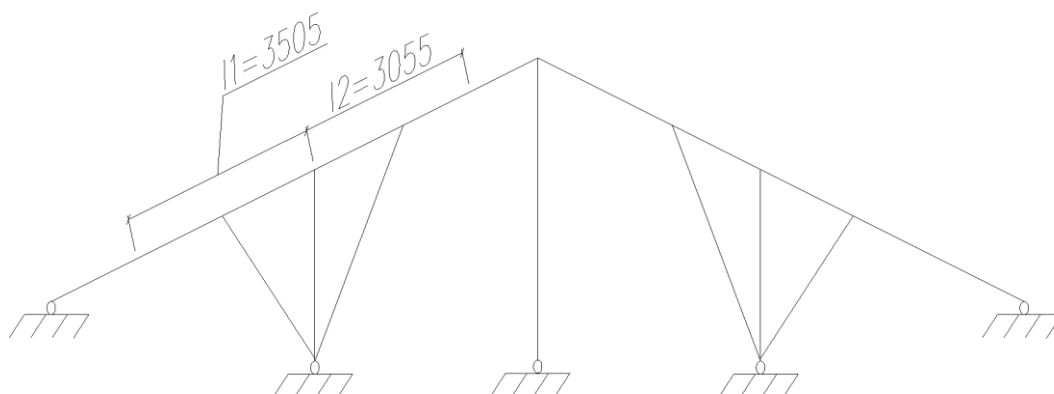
Расчетная нагрузка от простенка от конструкции кровли.
